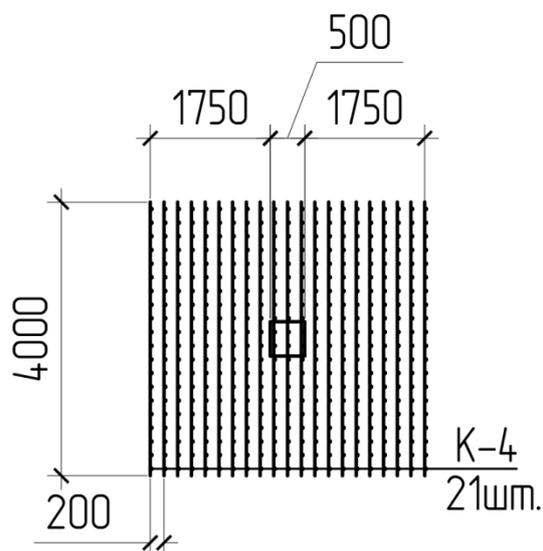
Фрагмент армирования плиты перекрытия в зоне продавливания
